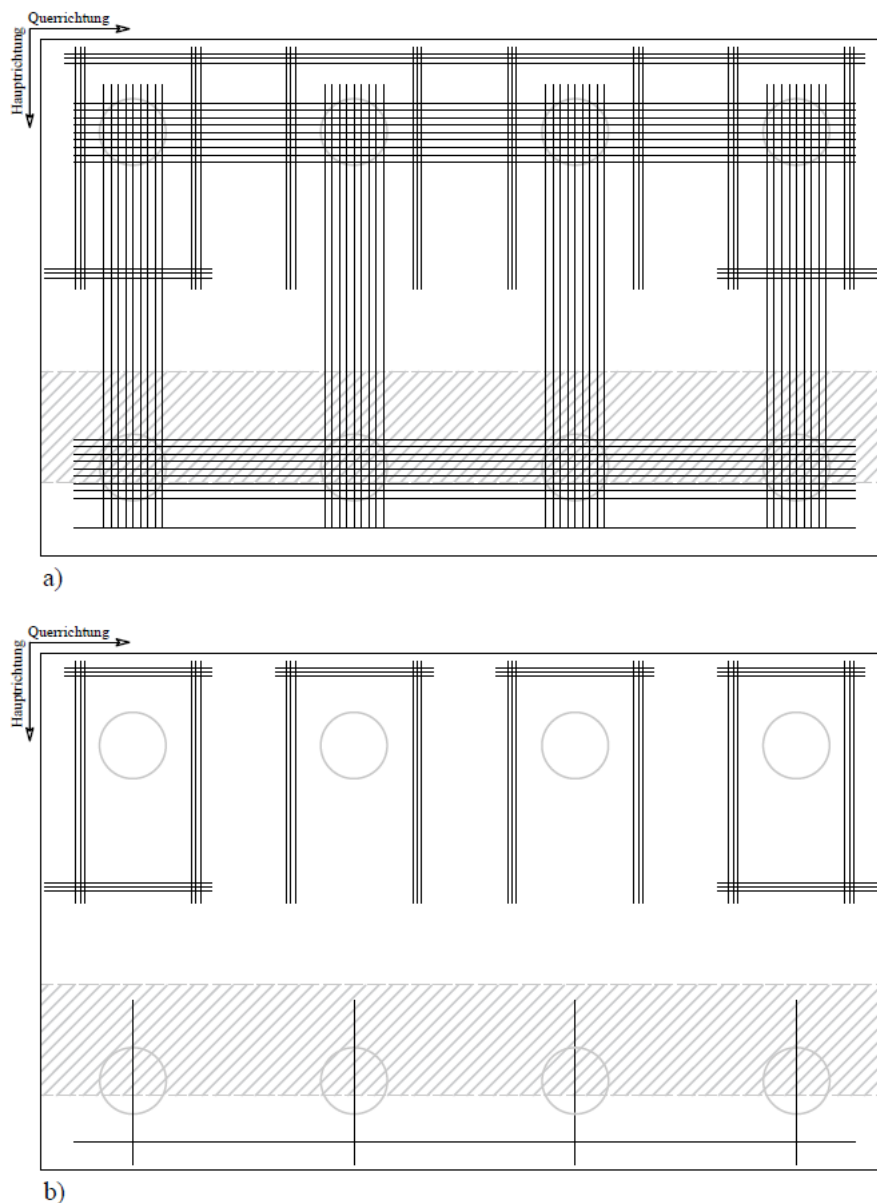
Variante 2 Lastfall 2 - a)Bewehrung unten, b)Bewehrung oben
